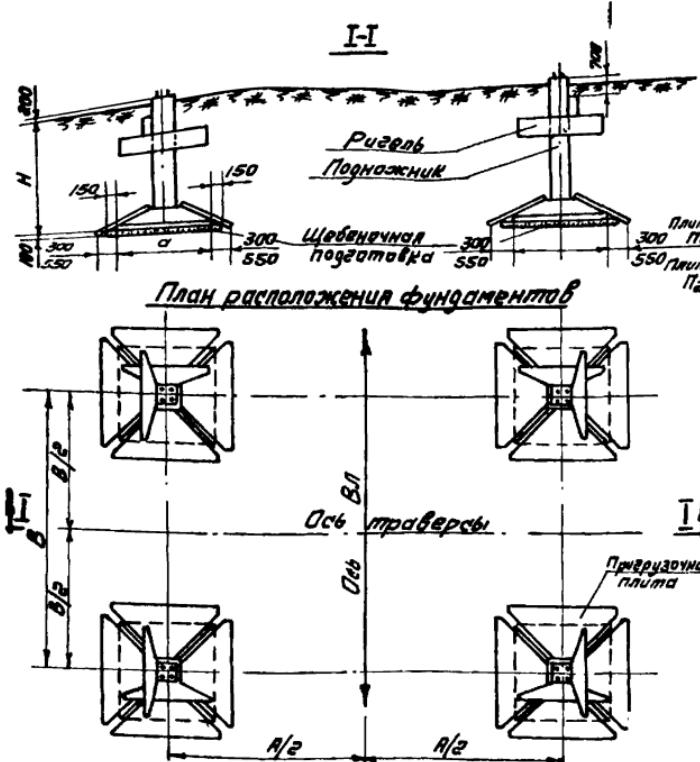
Схема расположения фундаментов под анкерно-чугловые опоры У1Ч2У1+5, У2+5, У1+12, У2+12
